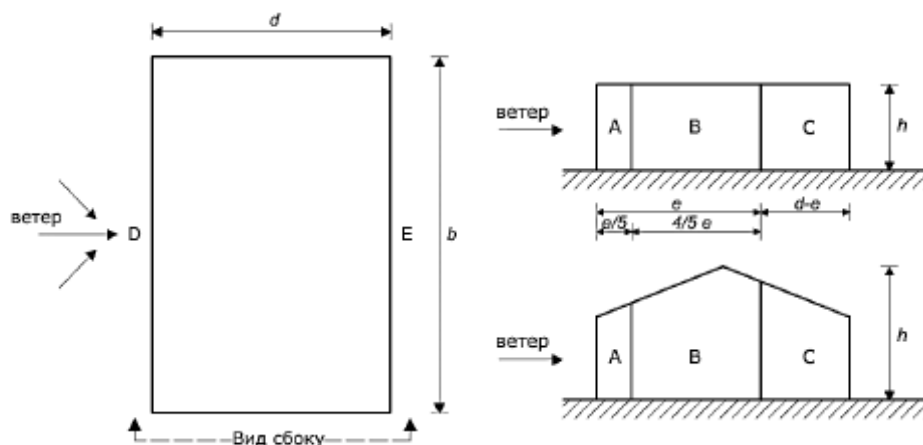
Схема здания для расчета ветрового воздействия на вертикальные стены
